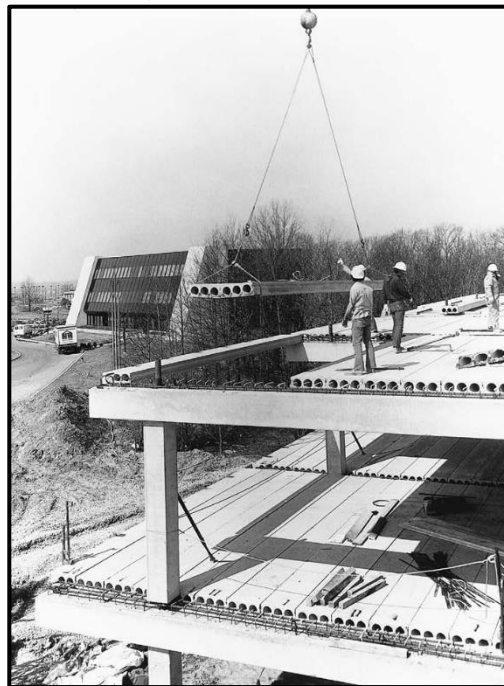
Edificio con elementos de losa apoyados en paneles largos (Allen e Iano, 2009).
